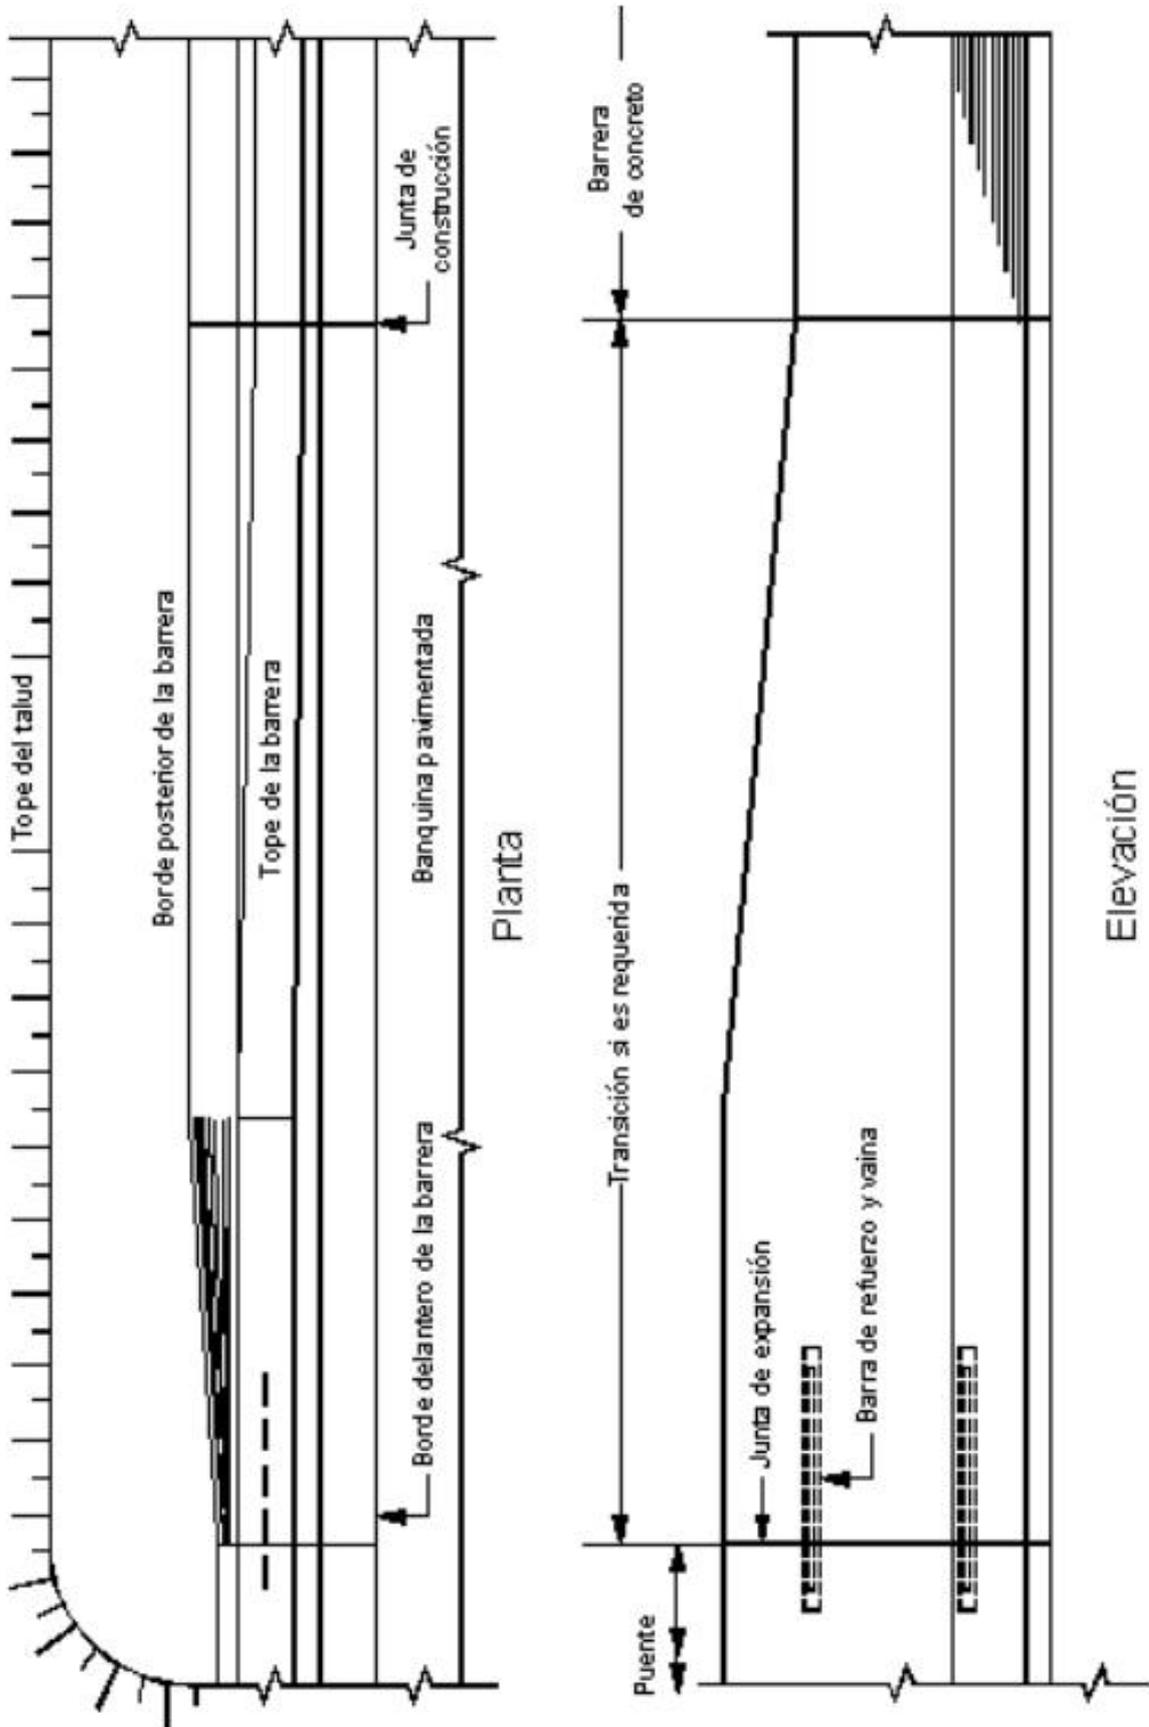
BARRERA DE CONCRETO EN LAS CERCANÍAS DE UN PUENTE
